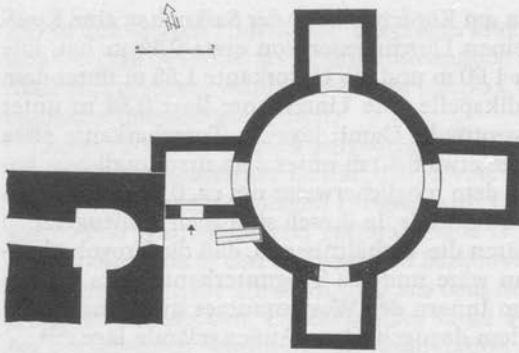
Konstanz, St. Mauritius, nach 940, Rekonstruktion des Grundrisses I, M. 1:500.
